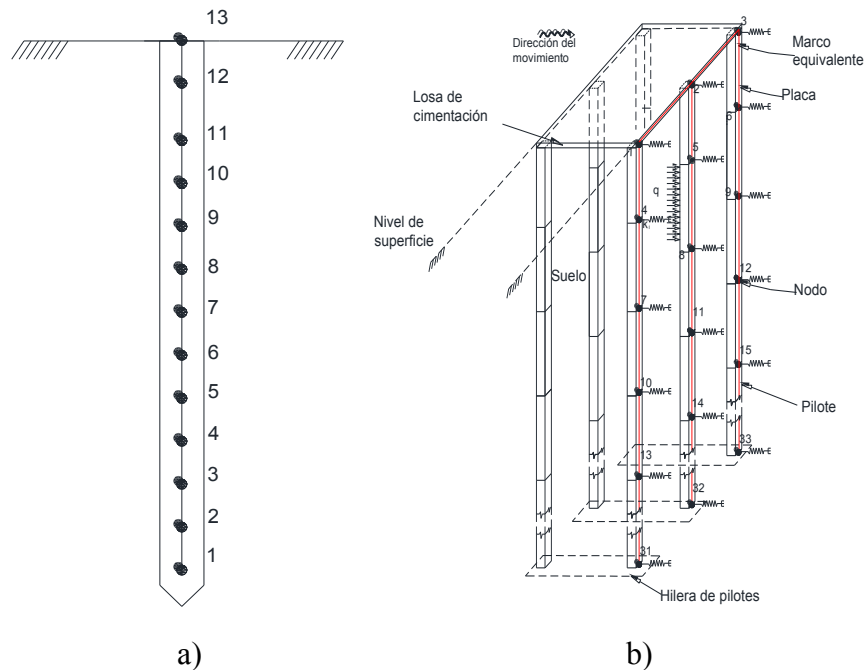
Casos estudios a) Pilote aislado, b) Losa de cimentación y pilotes
